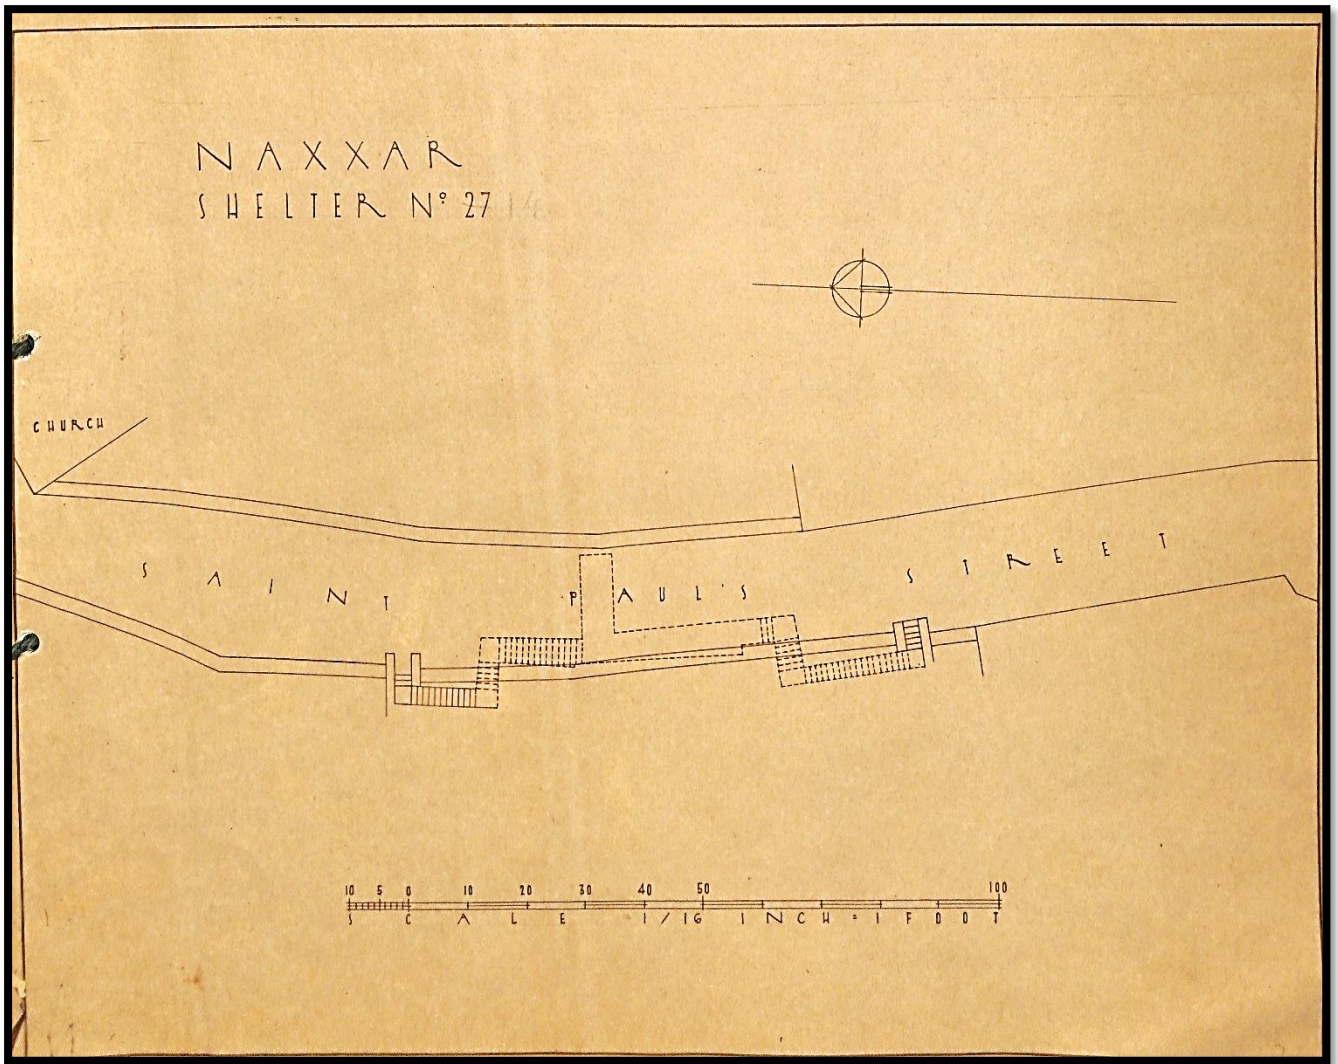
Planta do Abrigo nº27 (14) "Saint Paul's Street"
